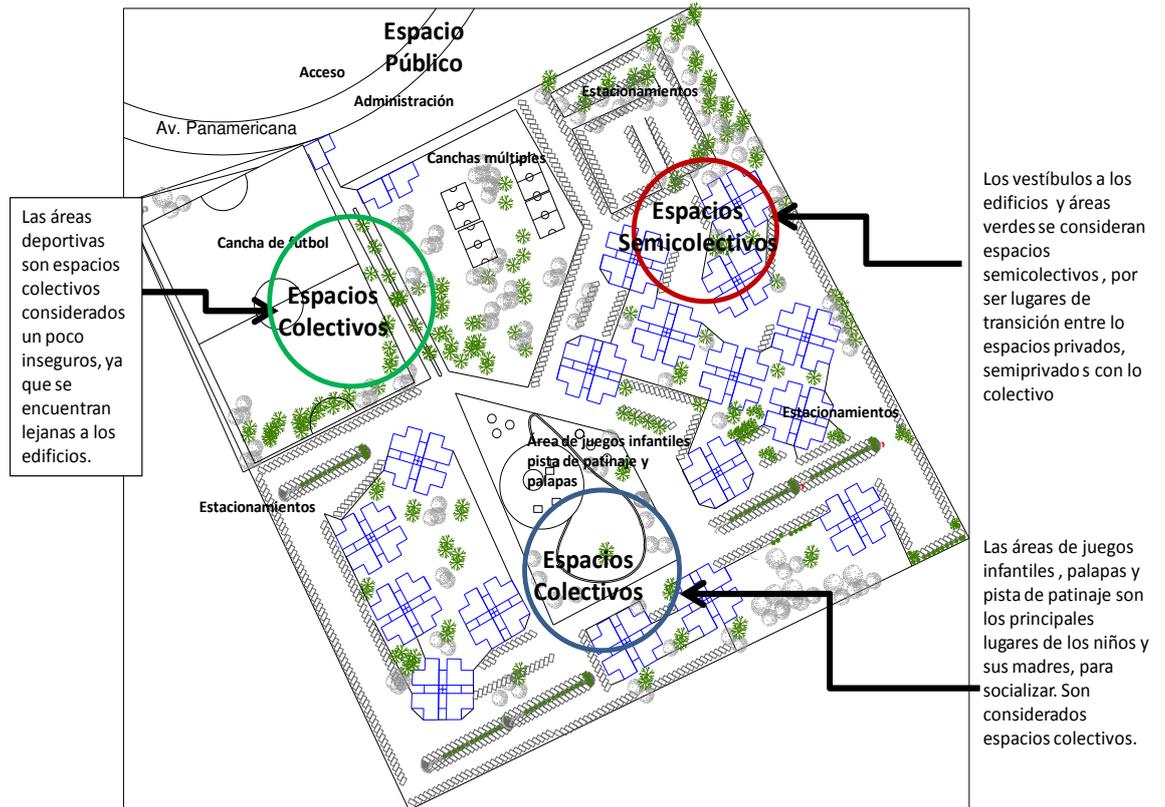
Fuente: Plano de conjunto Vistas de Maurel y Esquema de autoría propia.
